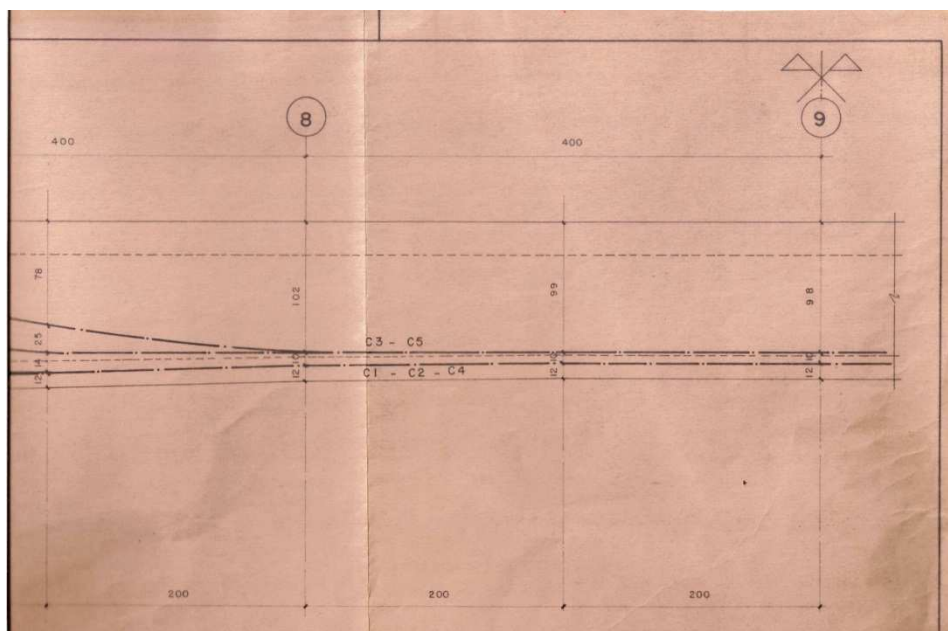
Corte Longitudinal – Meio do Vão (cm)
